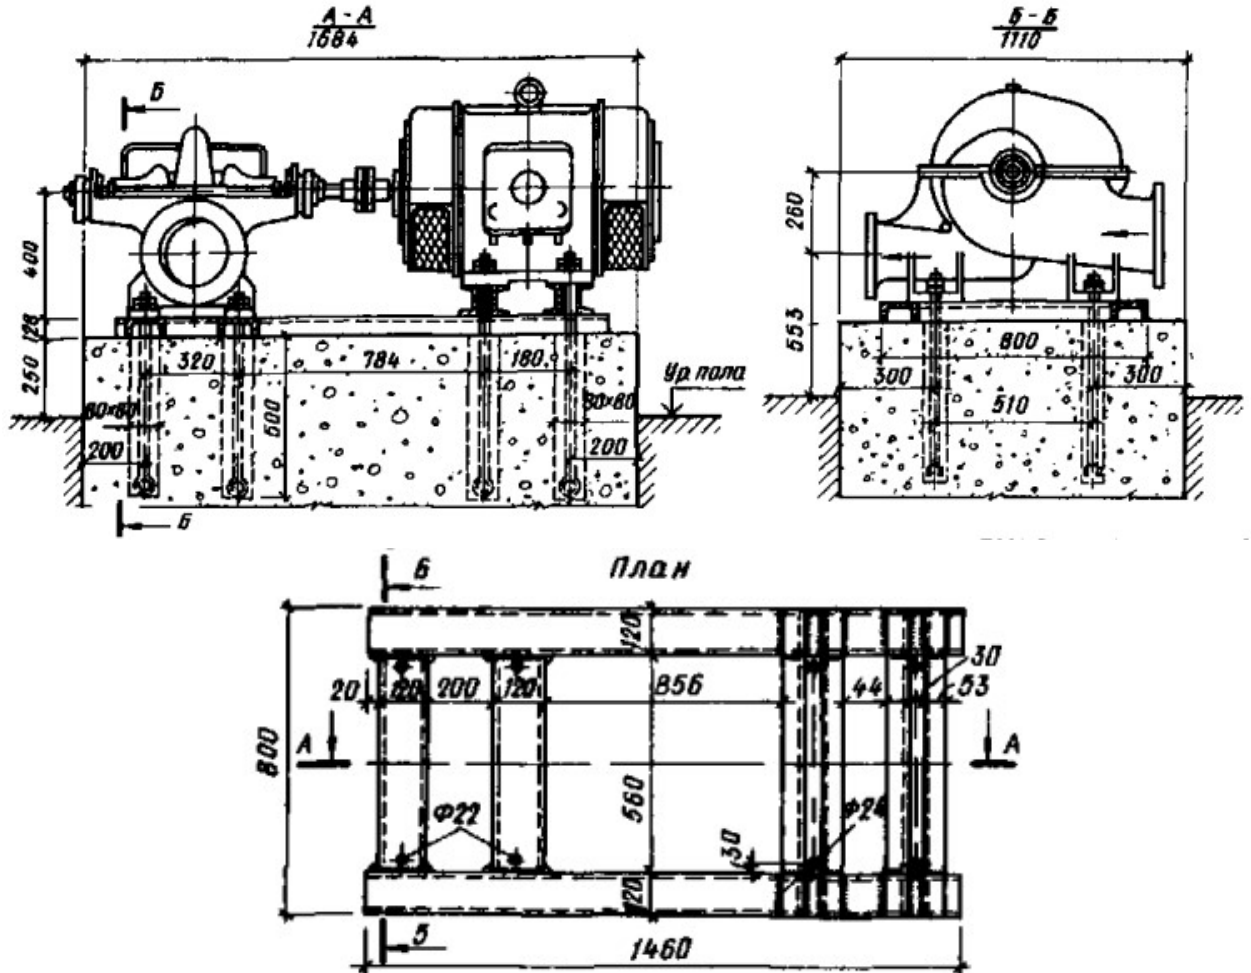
Окремий бетонний фундамент з металевою фундаментною плитою.
